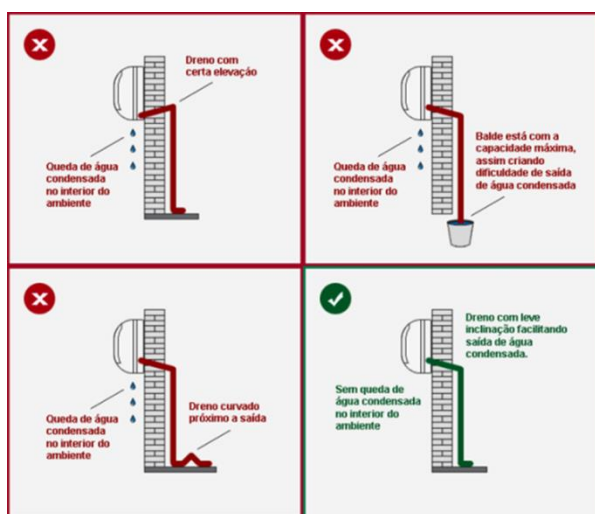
Guia de instalação do dreno de aparelhos do modelo split.
